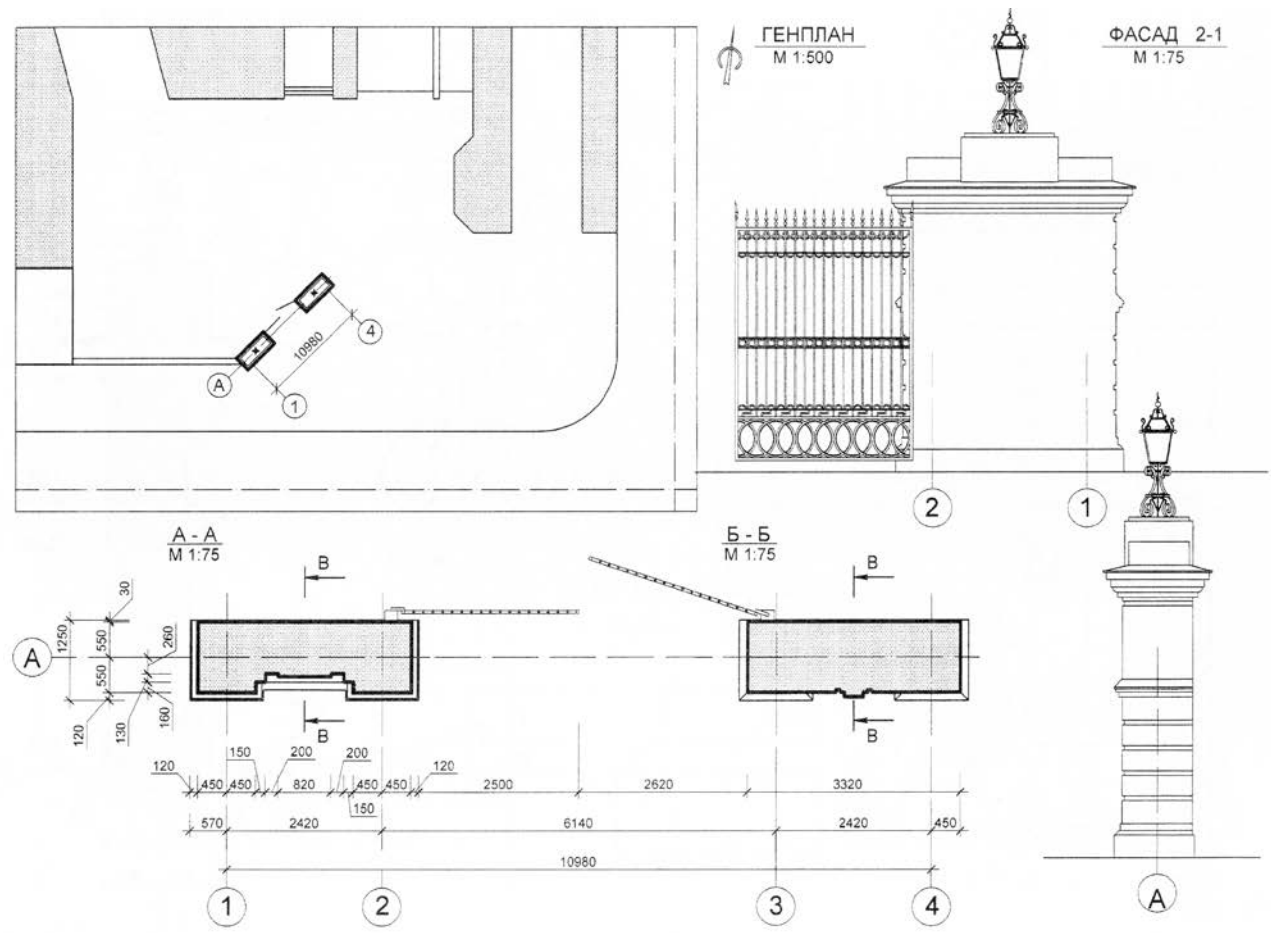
Примеры начертания генплана, плана, бокового фасада и фрагментов входной группы
